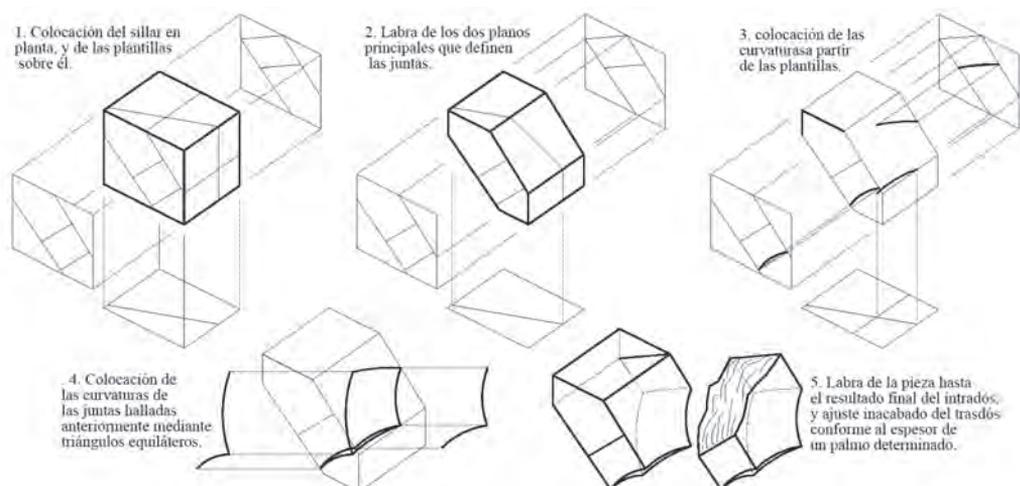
Imagen de la labra del sillar. A la izquierda se muestra éste colocado en planta, seguidamente con las plantillas colocadas y aristas marcadas, después con ambos planos principales ya labrados, luego con las curvaturas definidas sobre él, y finalmente acabado, listo para su disposición en obra.
